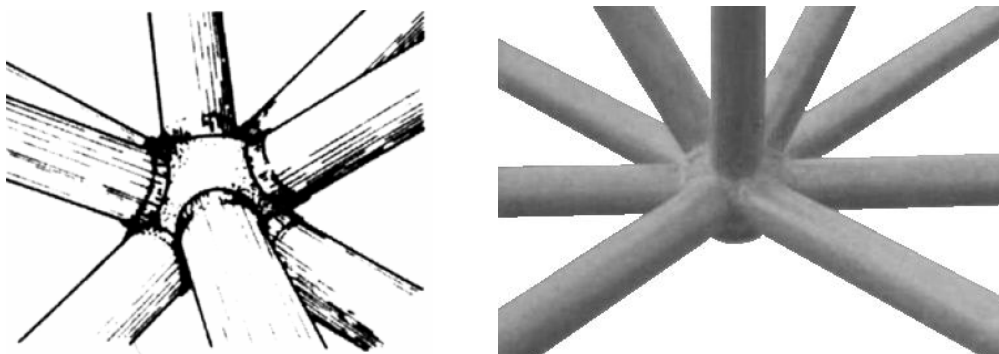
Sistema de nó OKTAPLATE – Alemanha (Makowski, 1968)
